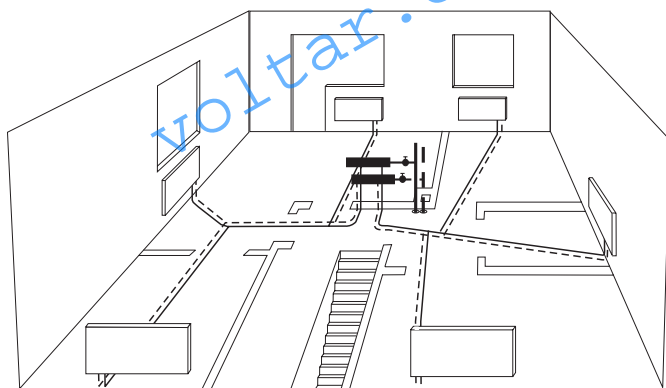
Прокладка трубопроводов с тройниками в горизонтальных перекрытиях – допускается при использовании соединений к запрессовке.
